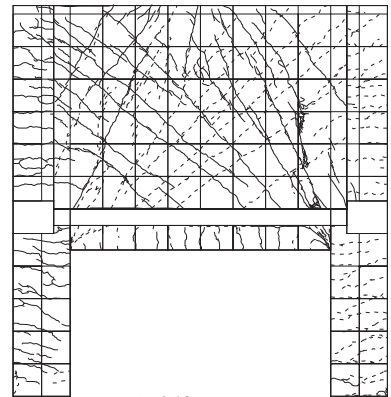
鉄筋降伏位置図 (最大変形に至るまで)
